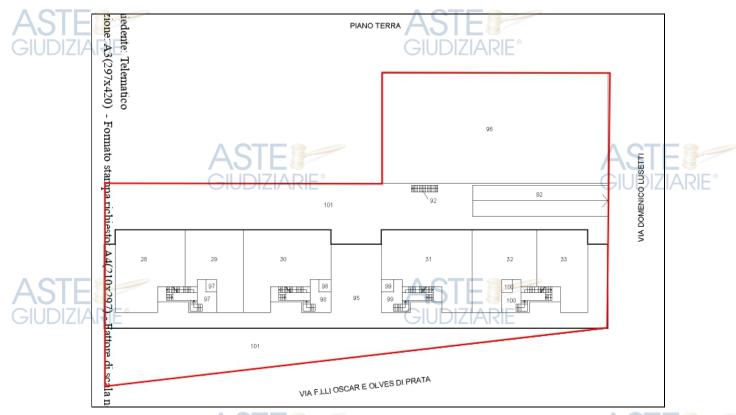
Estratto elaborato planimetrico ultimo in atti con indicazione del perimetro di proprietà condominiale
